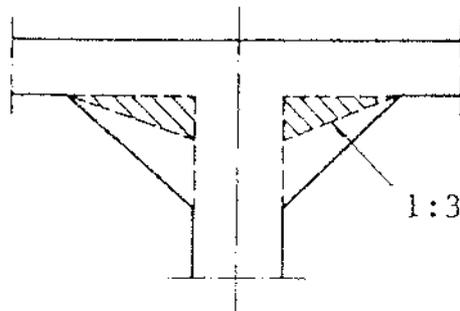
Consideración de un refuerzo en el dimensionamiento a flexión.
